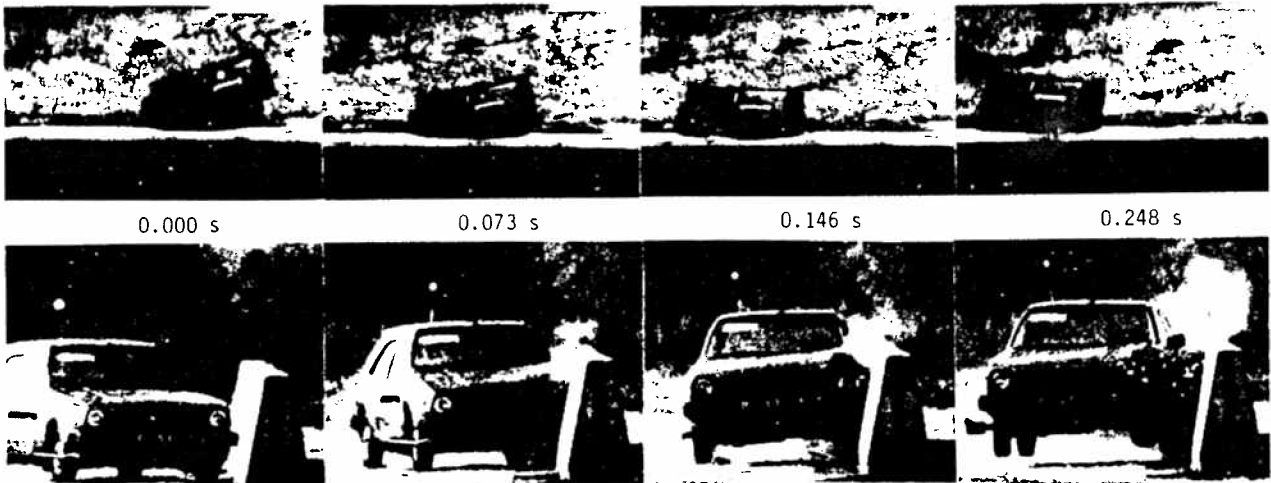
Overzicht van de aanrijding van een lichte personenauto tegen een wand met een hellingshoek van 10,8 graden.
